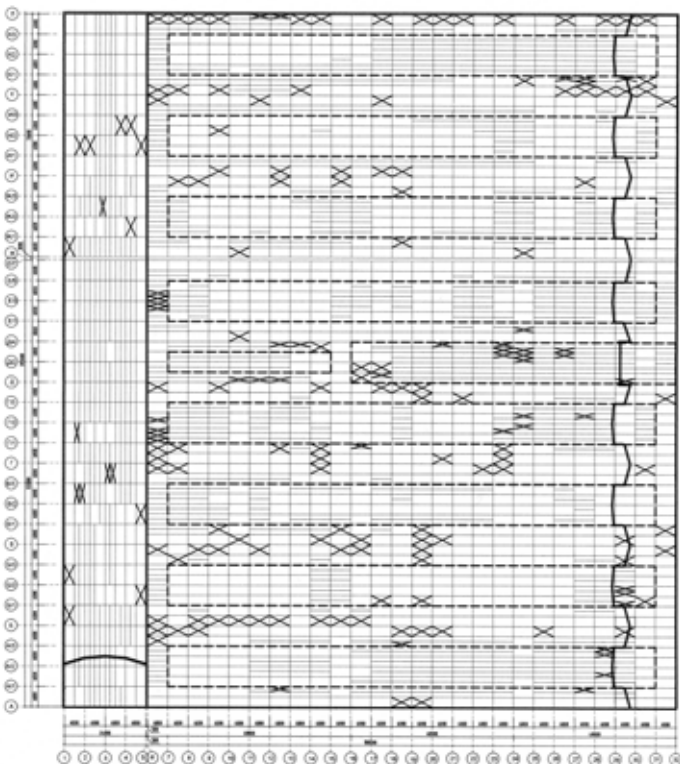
План даху будівлі зі схоластичним розташуванням типових ребристих плит покриття з різними розмірами в плані: 3×6м та 1,5×6м. На плані даху «X» позначені плити покриття, що знаходяться в аварійному стані.
